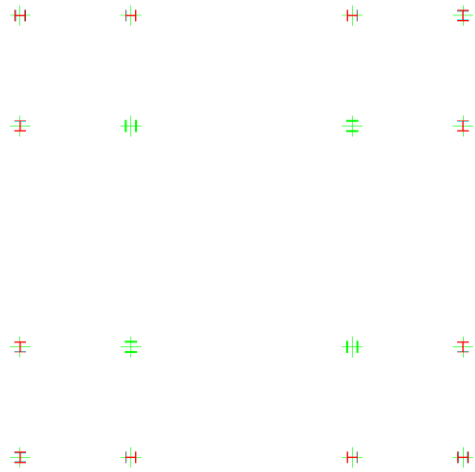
b Disposición de columnas en planta [elaboración propia]
